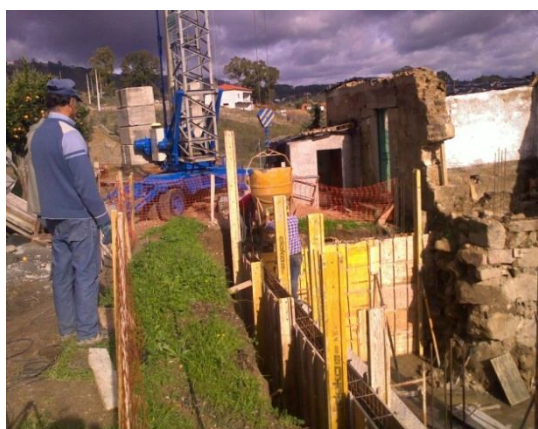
Cofragem dos muros de suporte da parte térrea e sua betonagem.
